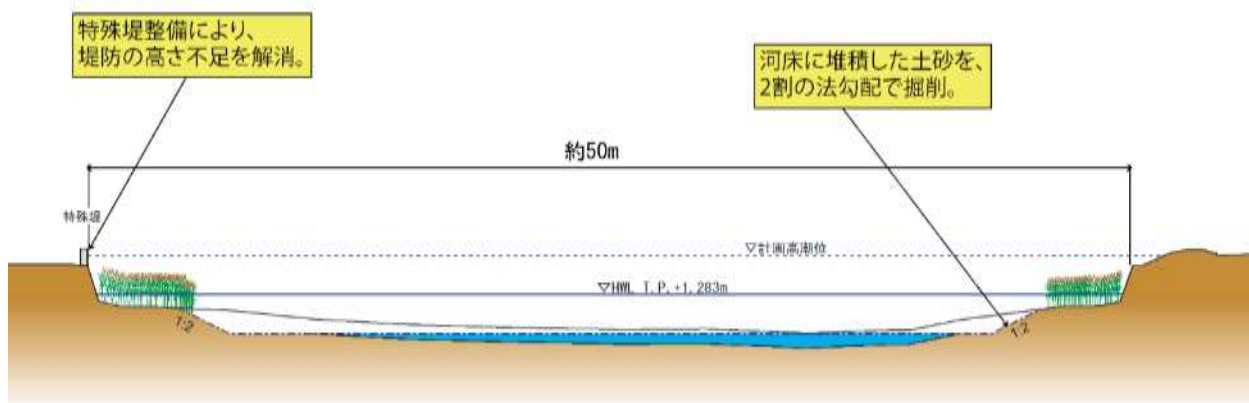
代表横断面図 河口～JR内房線下流区間 (No. 6 地点)
